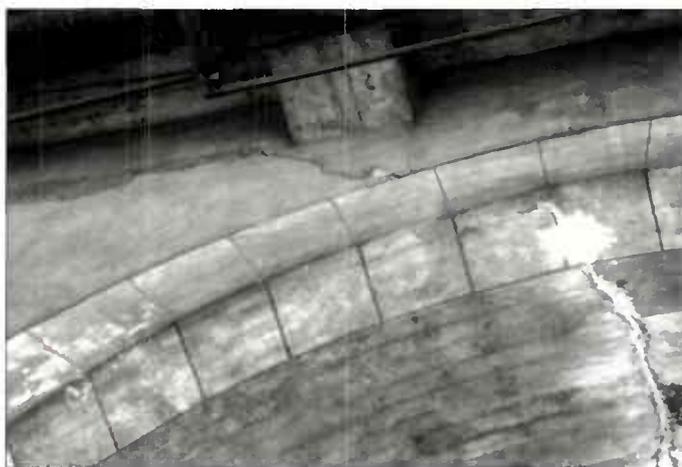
Cas d'un ouvrage défectueux : pont voûté en béton non armé fissuré.
